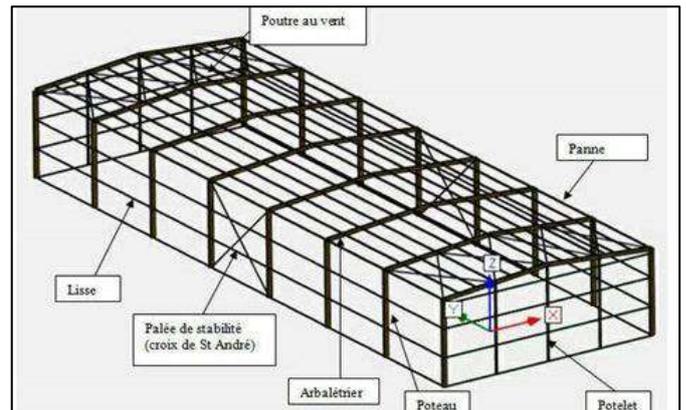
Construction par portiques préfabriqués Source : Leçon- Systèmes de construction en_ préfabrication. PDF
